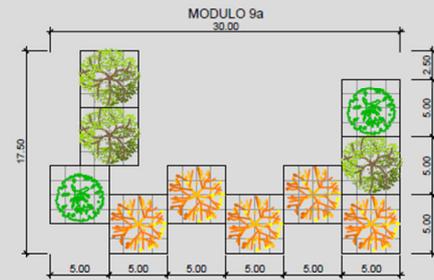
Stralcio planimetrico e sezione - Ambito K, Modulo 9 – Fosso Pantanella
